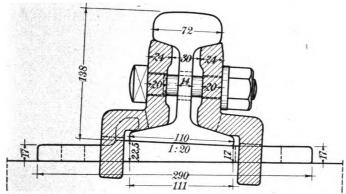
Querschnitt durch die Stoßverbindung. Profil 8b. M. 1:4
